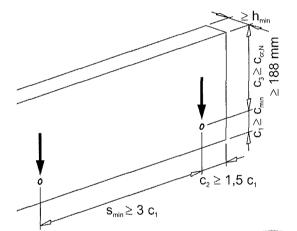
Einbausituation Wandfläche - Querbeanspruchung, ohne Rückhängebewehrung
